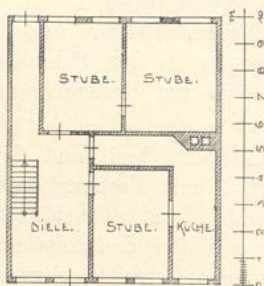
Johannisstraße 4. Grundriß eines Gerberhauses.
